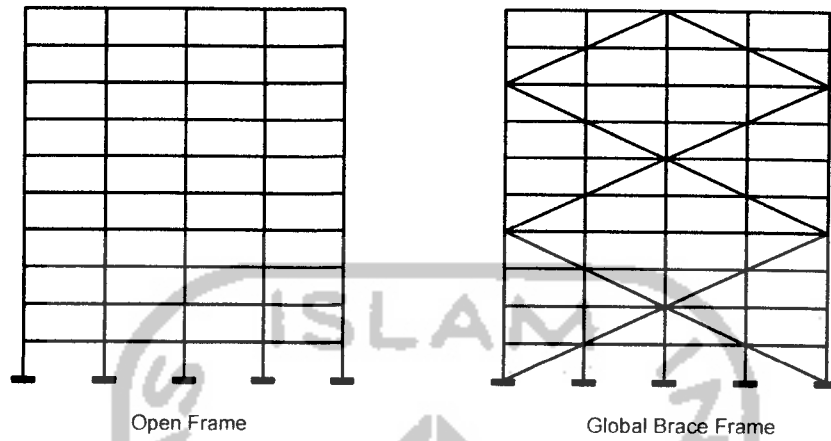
Denah Struktur tipe B (1 *Global braced* menahan 4 *OpenFrame*)
